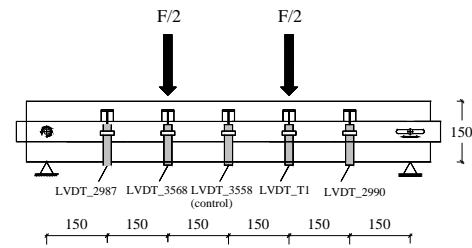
Esquema geral do ensaio das vigas da série B (dimensões em mm).
